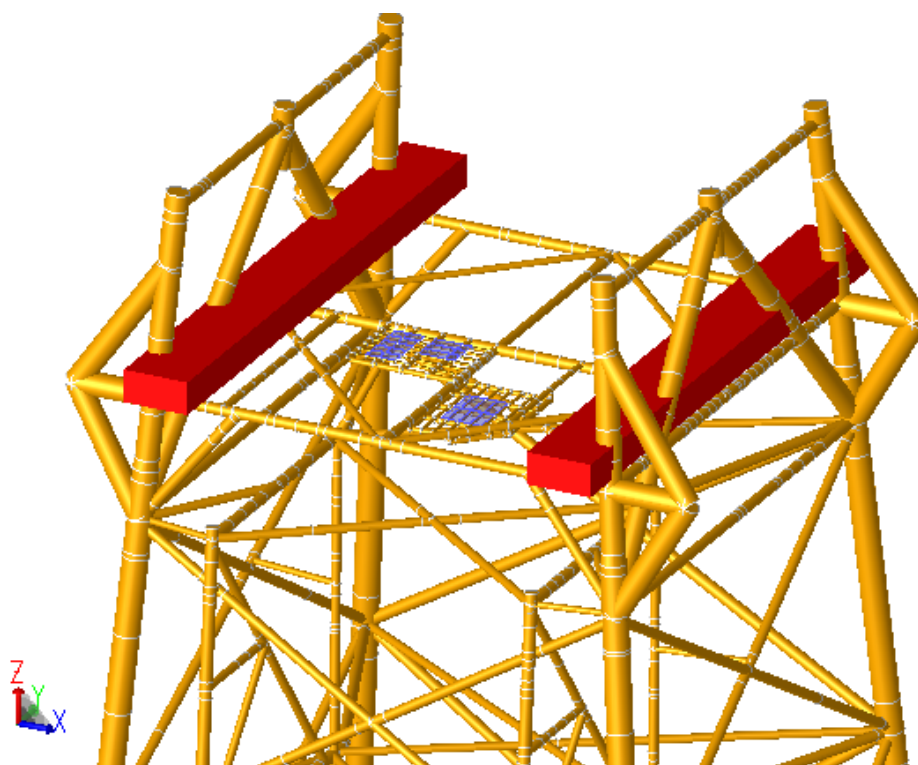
Viga inclinada projetada para a jaqueta (esquemática)
